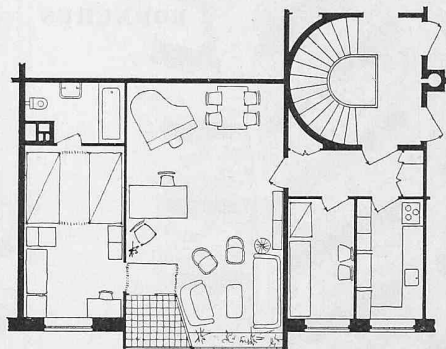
Grundriss einer Wohnung der Wohnhäuser in Ibstrupvoenge. 1:200.
